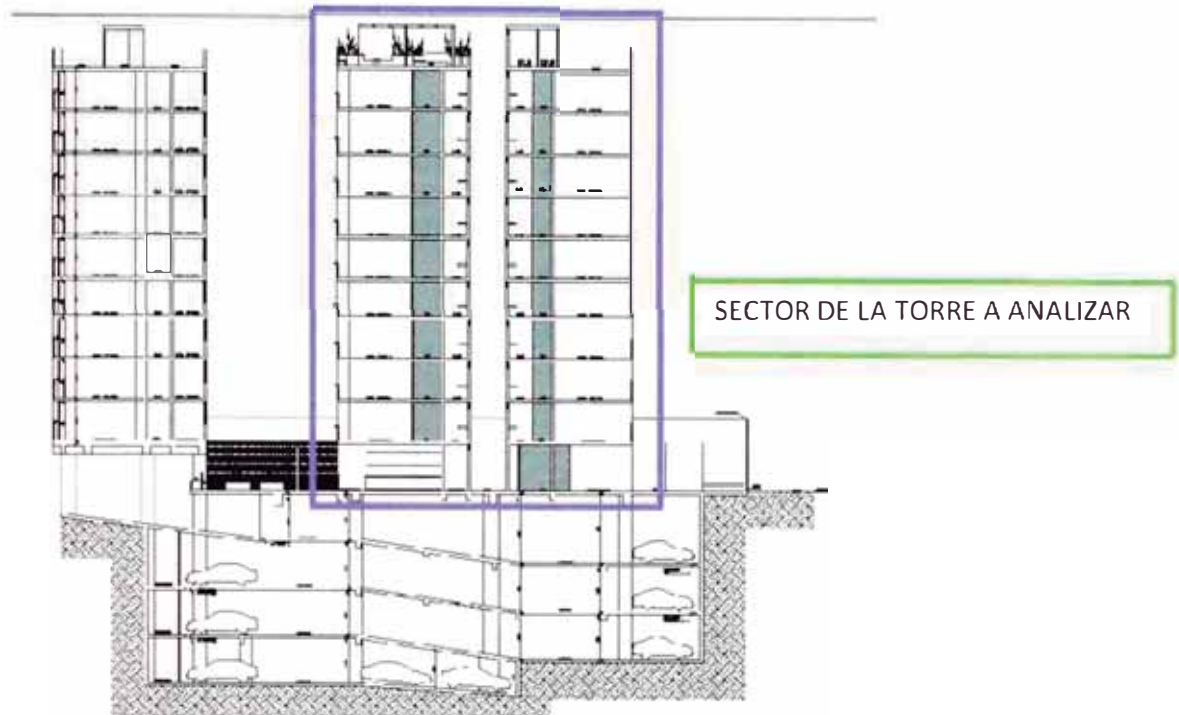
Plano en corte edificio (Fuente: Lugano)
